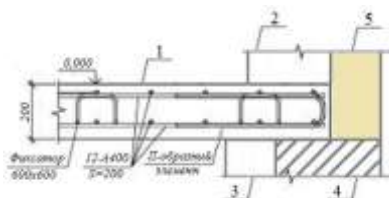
Железобетонная монолитная плита пола: 1 – плита пола, 2 – монолитная колонна, 3 – отдельный столбчатый монолитный фундамент, 4 – монолитный ленточный фундамент, 5 – наружное стеновое ограждение (цоколь)
